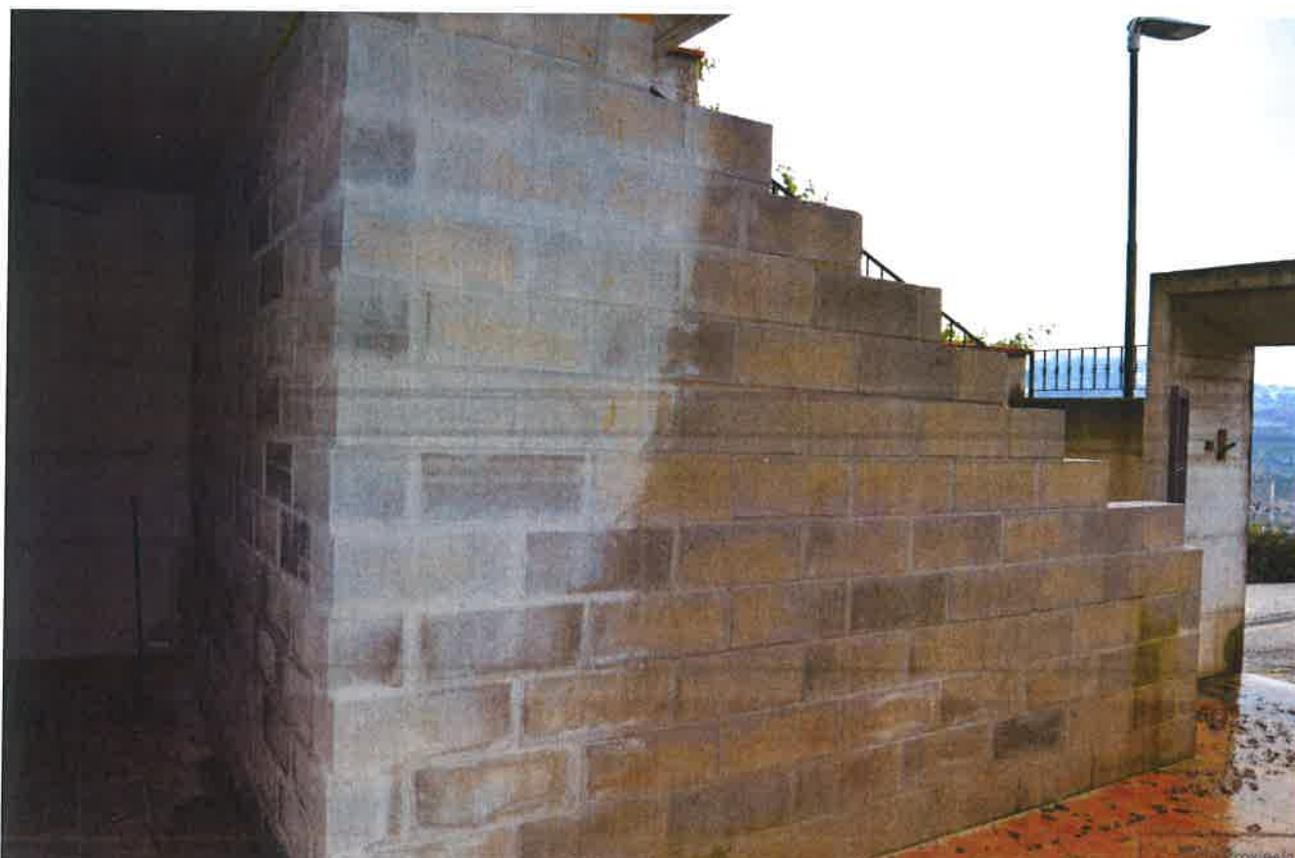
vista nuovo terrapieno su corte esterna realizzato in blocchetti in cemento.
